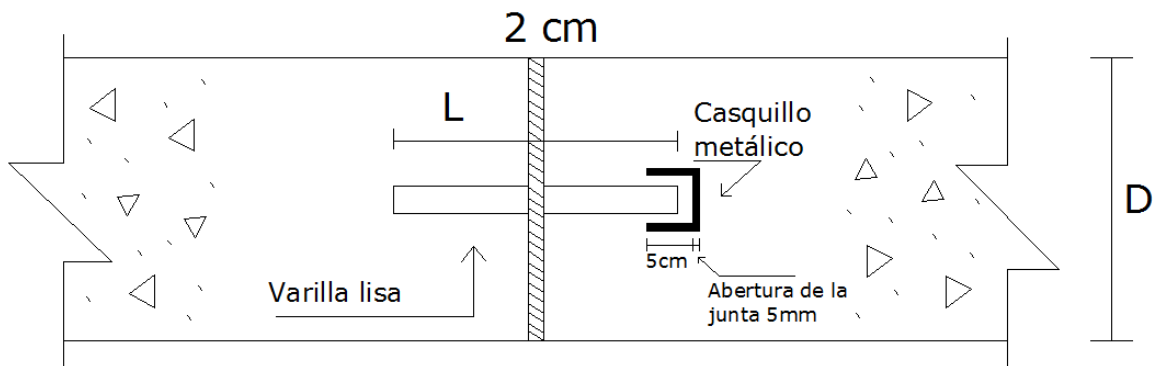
Junta de expansión con pasajuntas para pavimentos rígidos.
